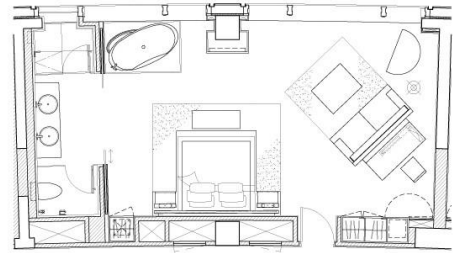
Vues sur les suites (Source : <https://www.archdaily.com>)
